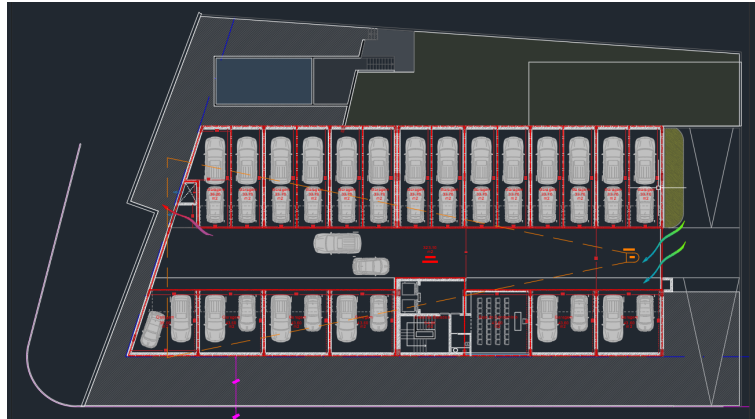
Planta do Piso -1 - Ventilador de Impulso
